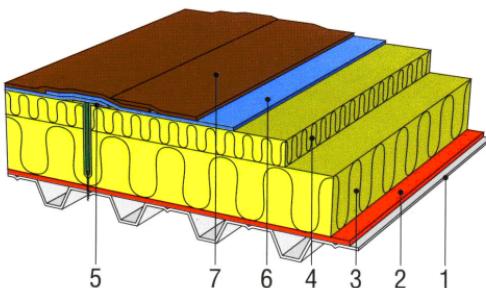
Двухслойное теплоизоляционное решение кровли с двухслойным наплавляемым гидроизоляционным ковром и механическим креплением: 1 — несущий стальной профилированный настил; 2 — пароизоляционный слой из плит РУФ БАТТС Н; 3 — теплоизоляционный слой из плит РУФ БАТТС В; 5 — механическое крепление (саморез); 6 — нижний слой наплавляемого гидроизоляционного ковра; 7 — верхний наплавляемый гидроизоляционный ковер
